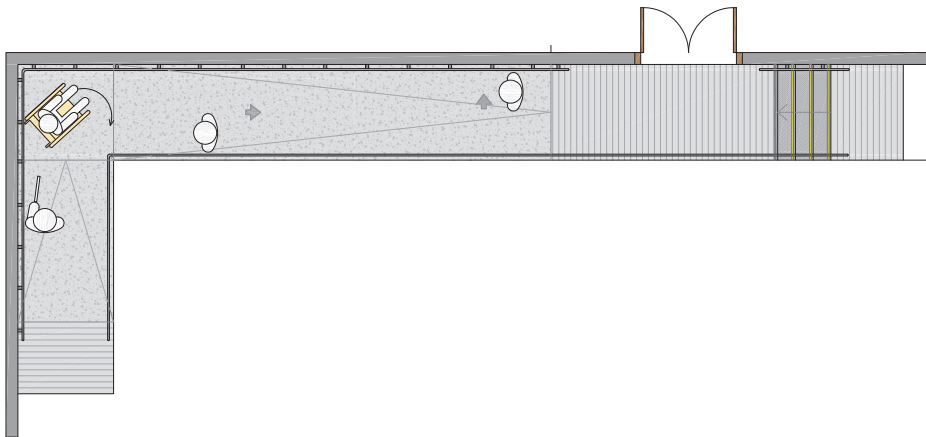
Vista en planta de una rampa en esquina y detalle de encuentro con escalera y puerta de acceso a otra dependencia.
